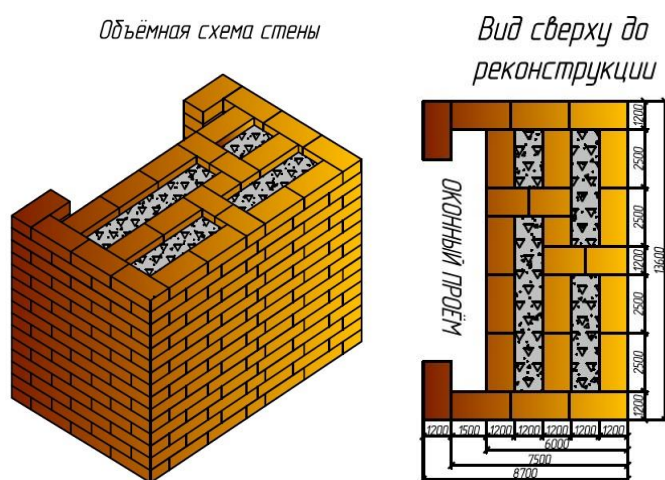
Схема колодцевой кладки в наружной стене (до реконструкции)
